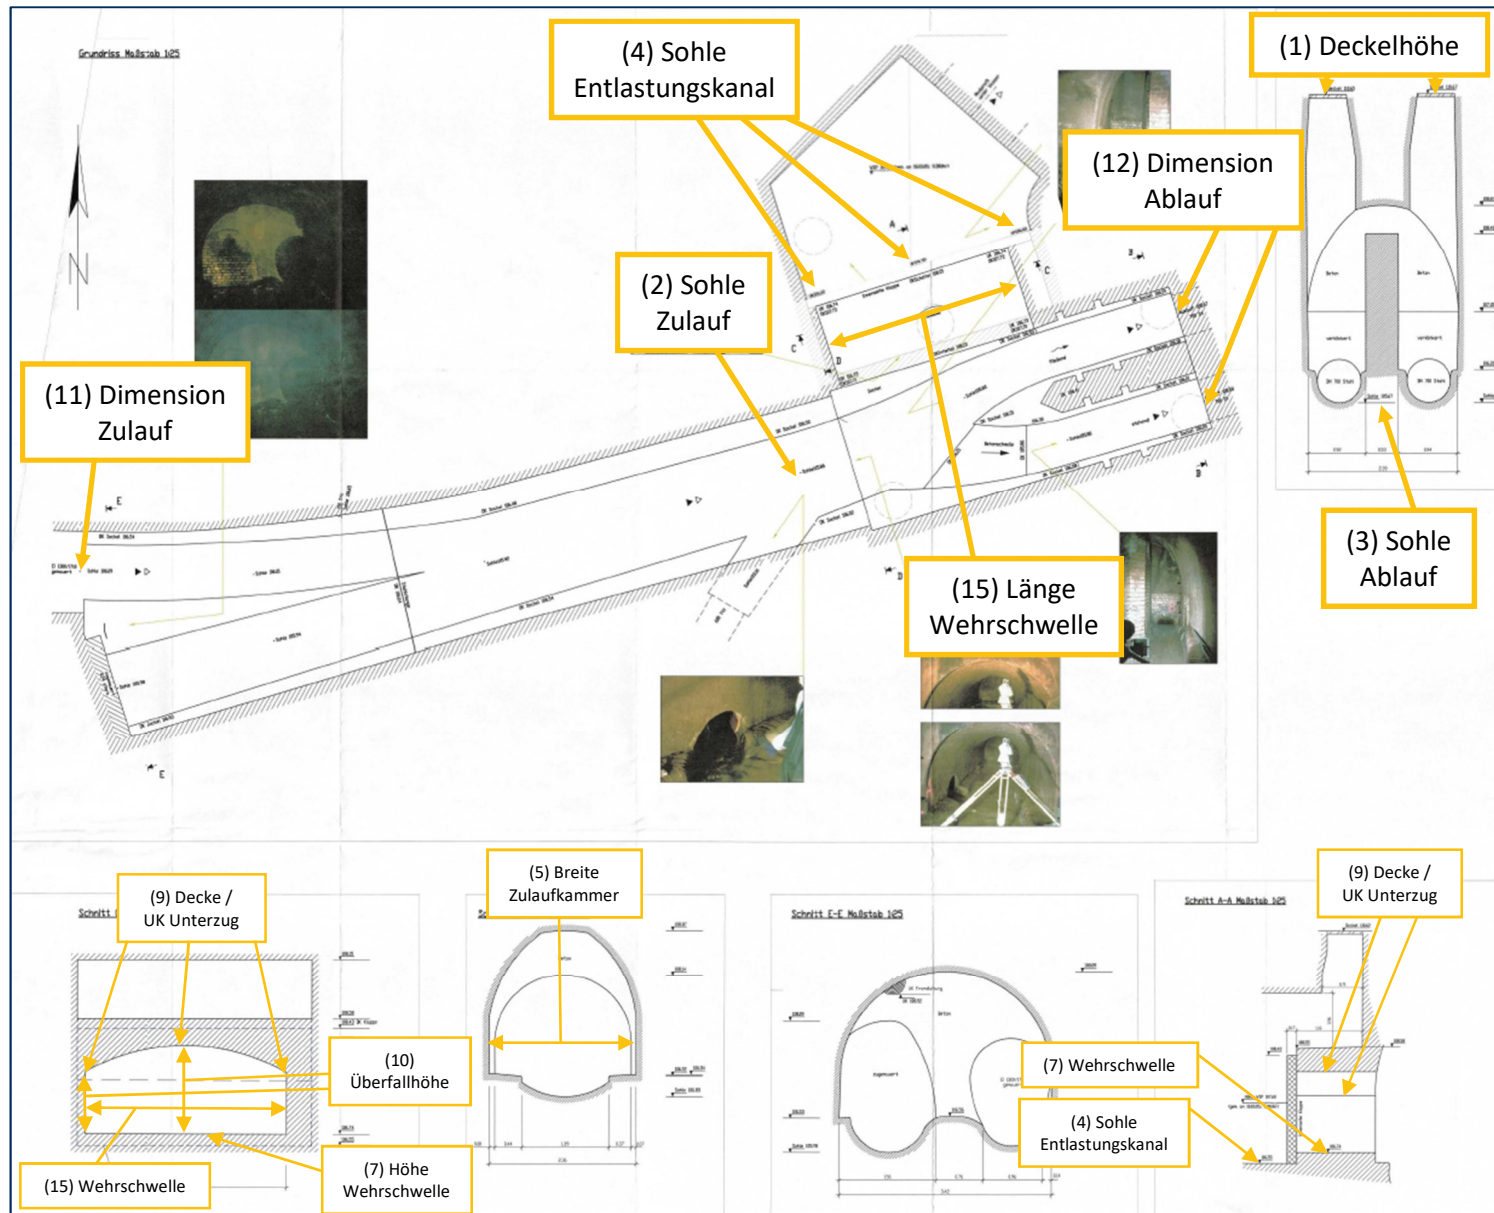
Beispiel Mischwasserentlastungsbauwerk Grundriss und Schnittdarstellung
